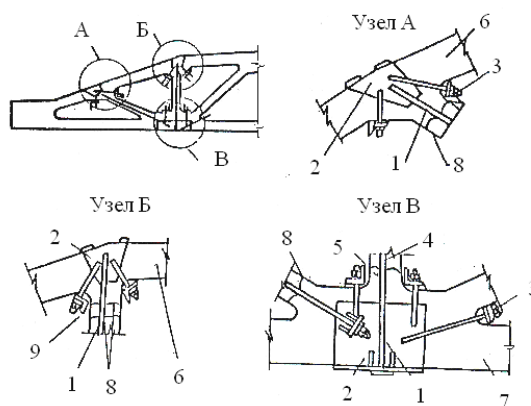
Вариант восстановления и усиления раскоса и стойки фермы предварительно напряженными затяжками:
